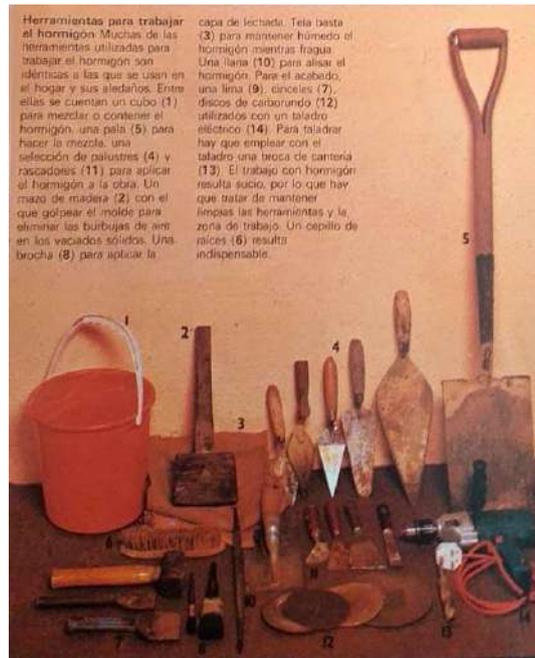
Ferramentas para trabalhar concreto ou argamassa
